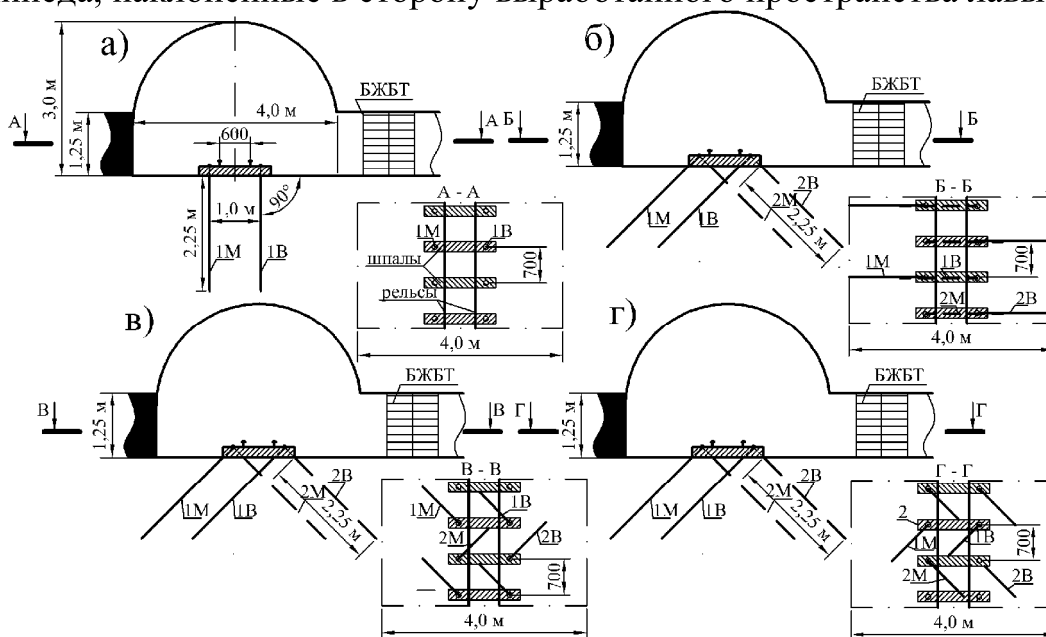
Схемы расположения анкеров в почве подготовительной выработки
